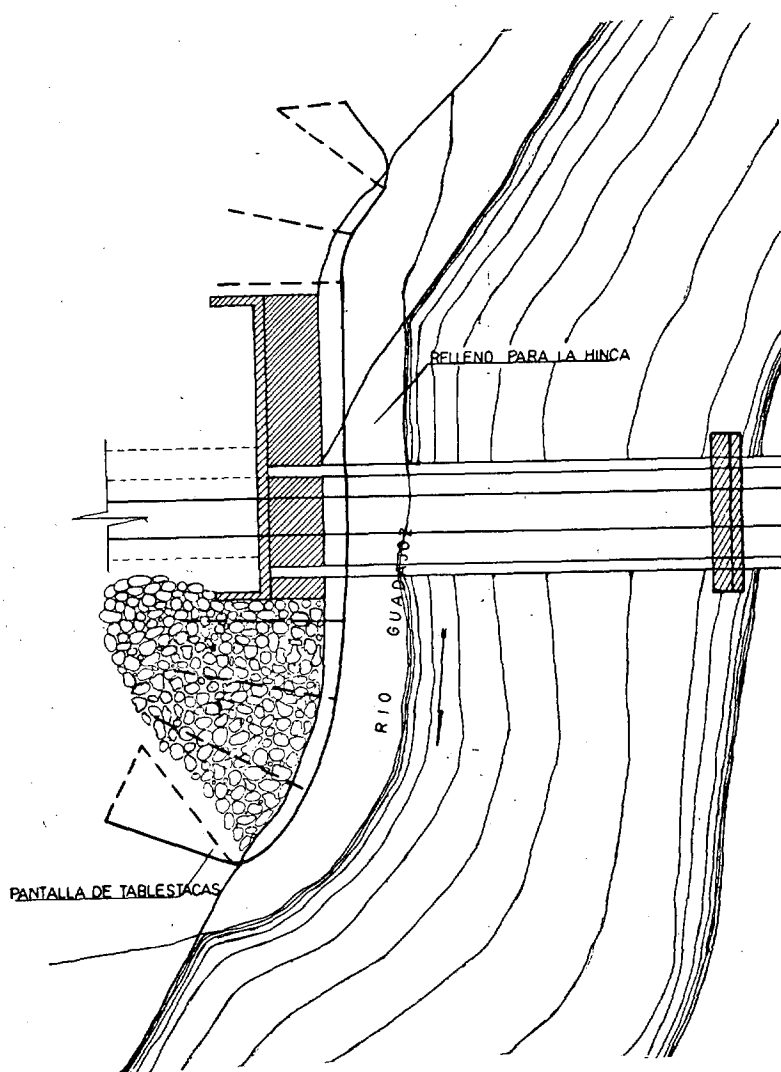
Defensa de un estribo en el puente de Las Arcas.
